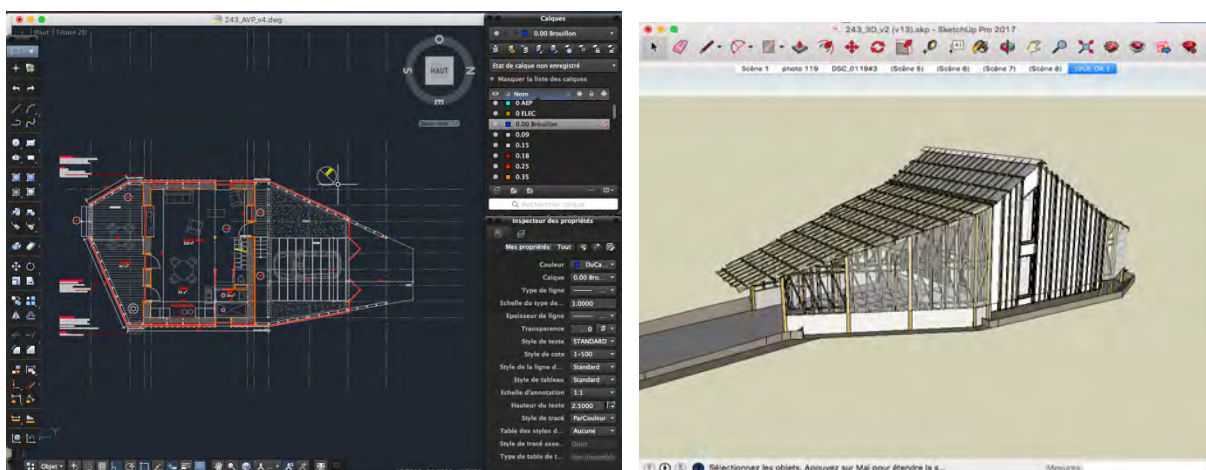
Capture d'écran d'un même projet sur AutoCAD (à gauche) et SketchUp (à droite)
